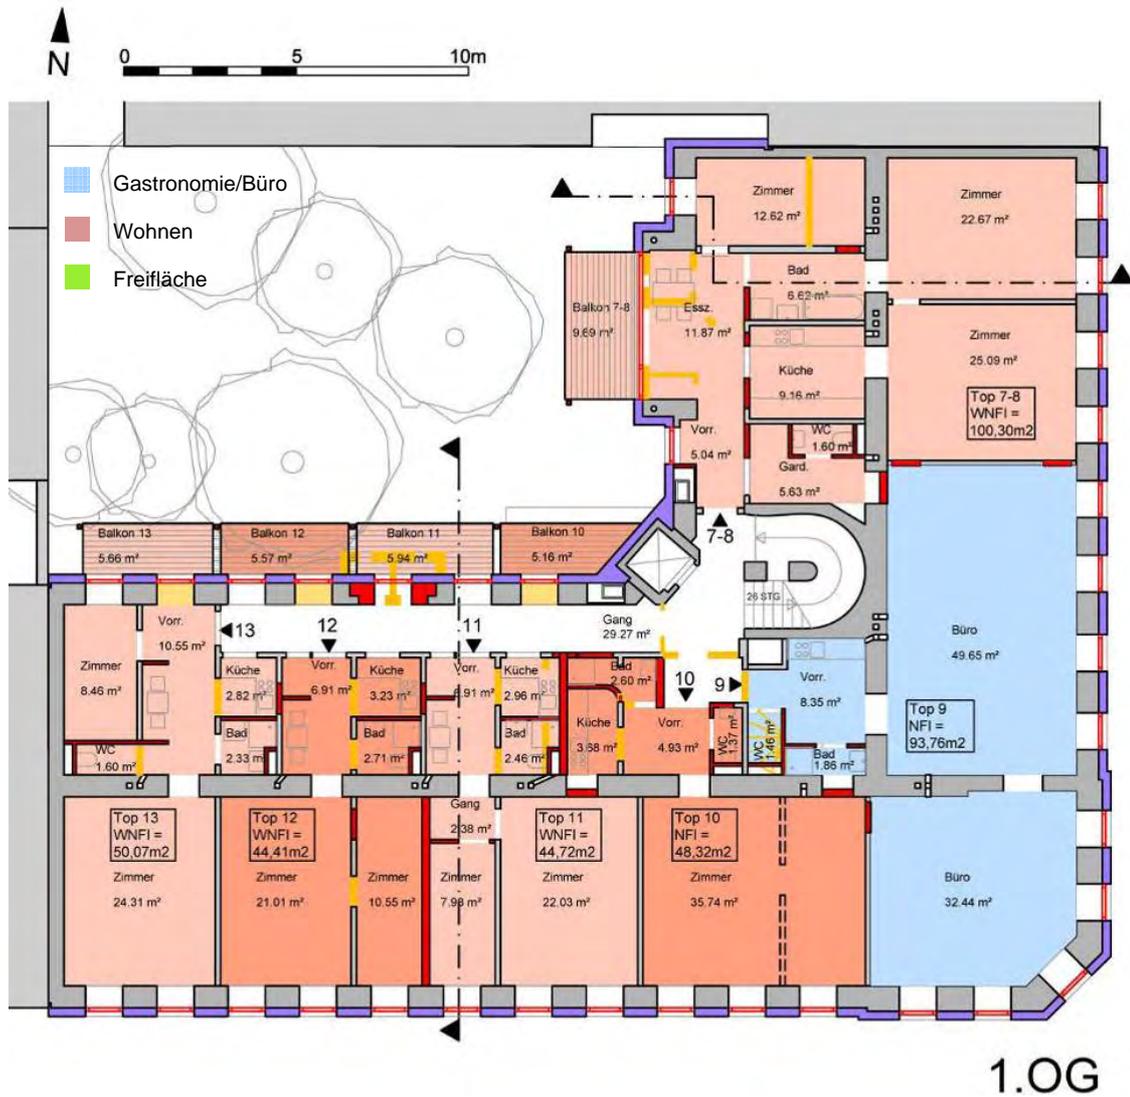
Grundriss 1. Obergeschoß
